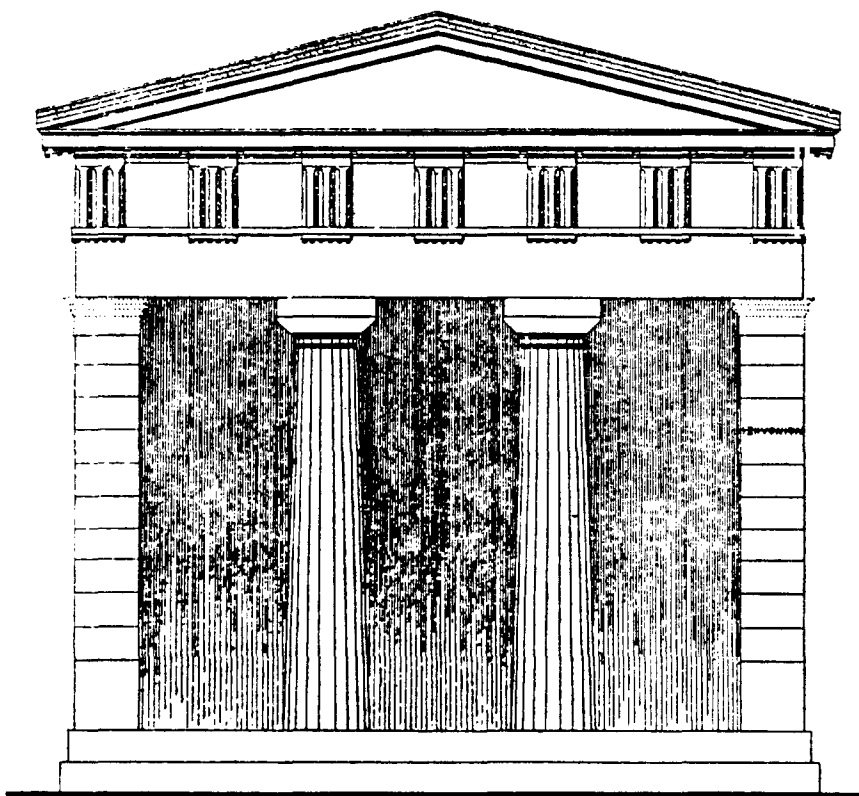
Fachada y frontón del Tesoro de Sición.
